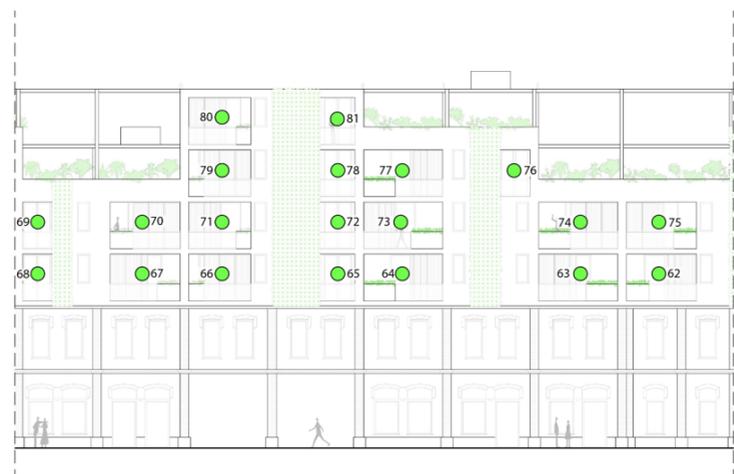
Schema in prospetto e sezione dei ricevitori R_B .
